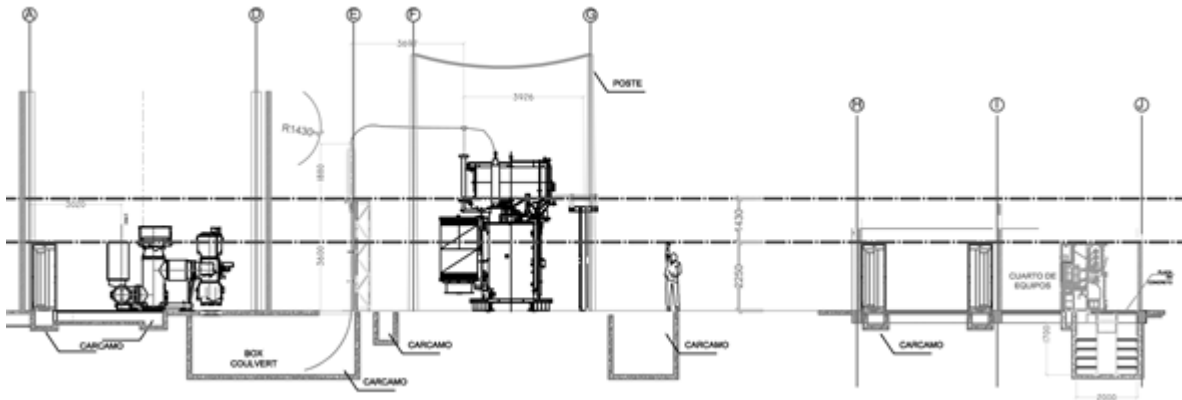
PLANTA SUBESTACIÓN SAN JOSÉ
